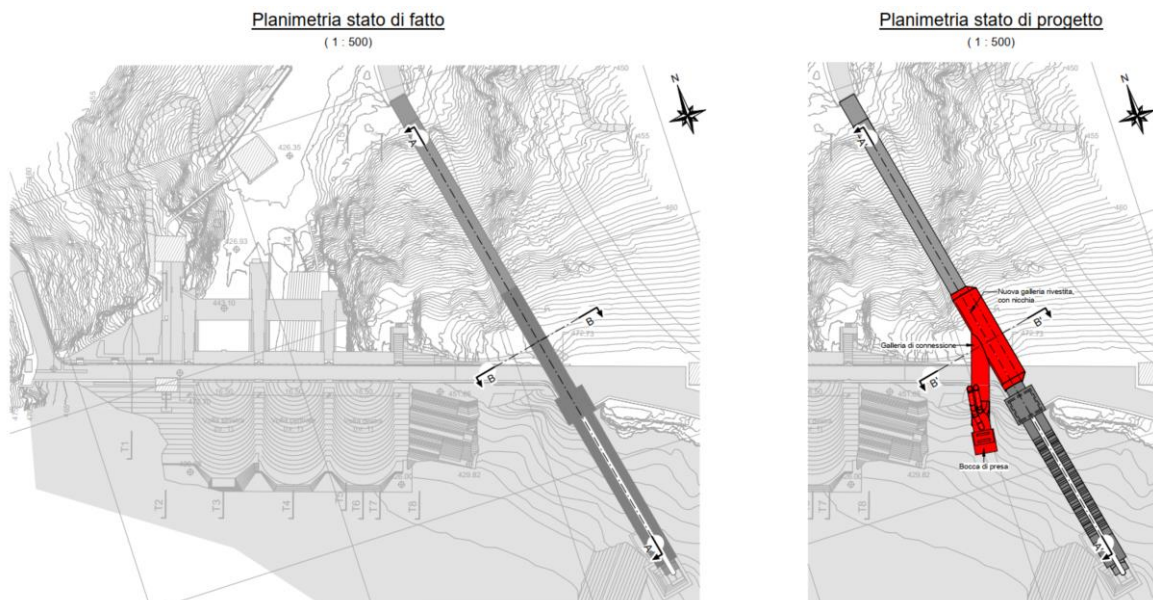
Confronto planimetrico tra lo stato di fatto e di progetto. In rosso sono evidenziate le opere in progetto.
